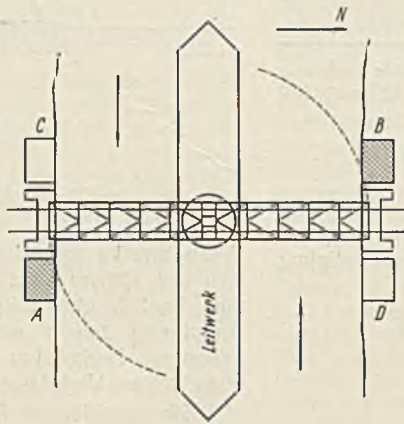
Lage des Bedienungshauses (zwei Durchfahrten).
